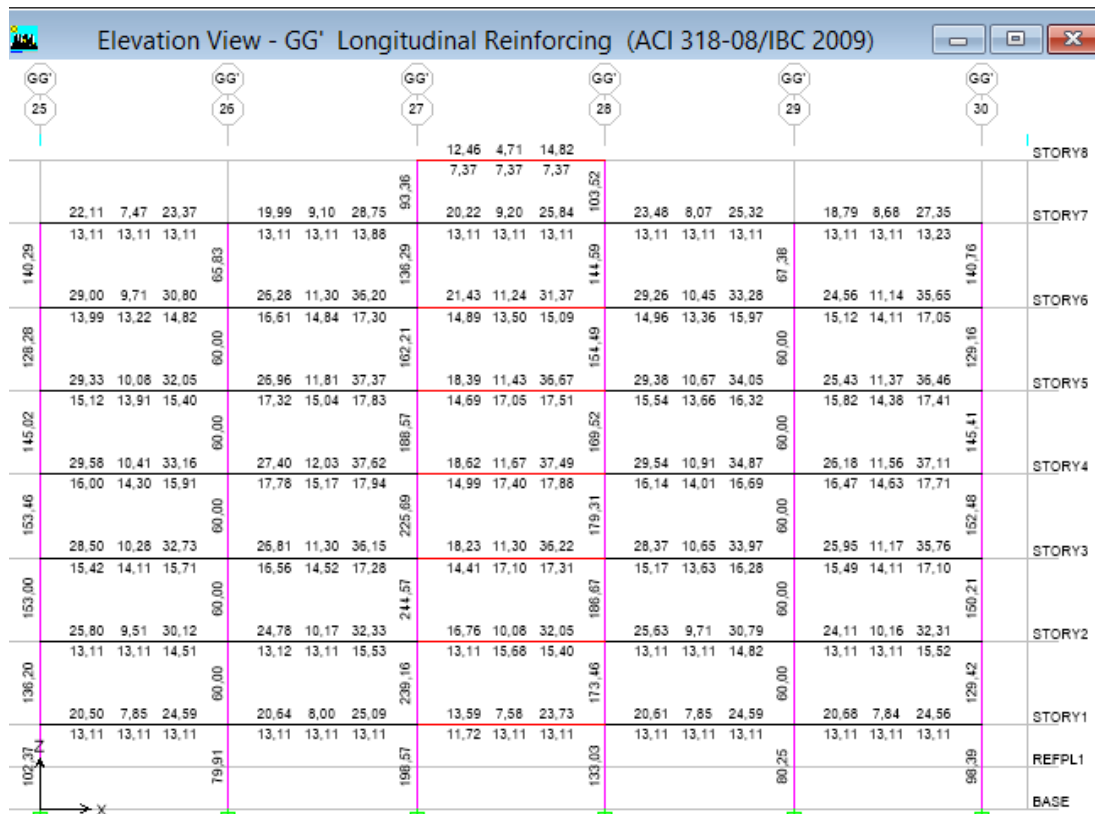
Acero en Vigas y Columnas en el Pórtico GG – Hospitalización 2- (NEC-11)
